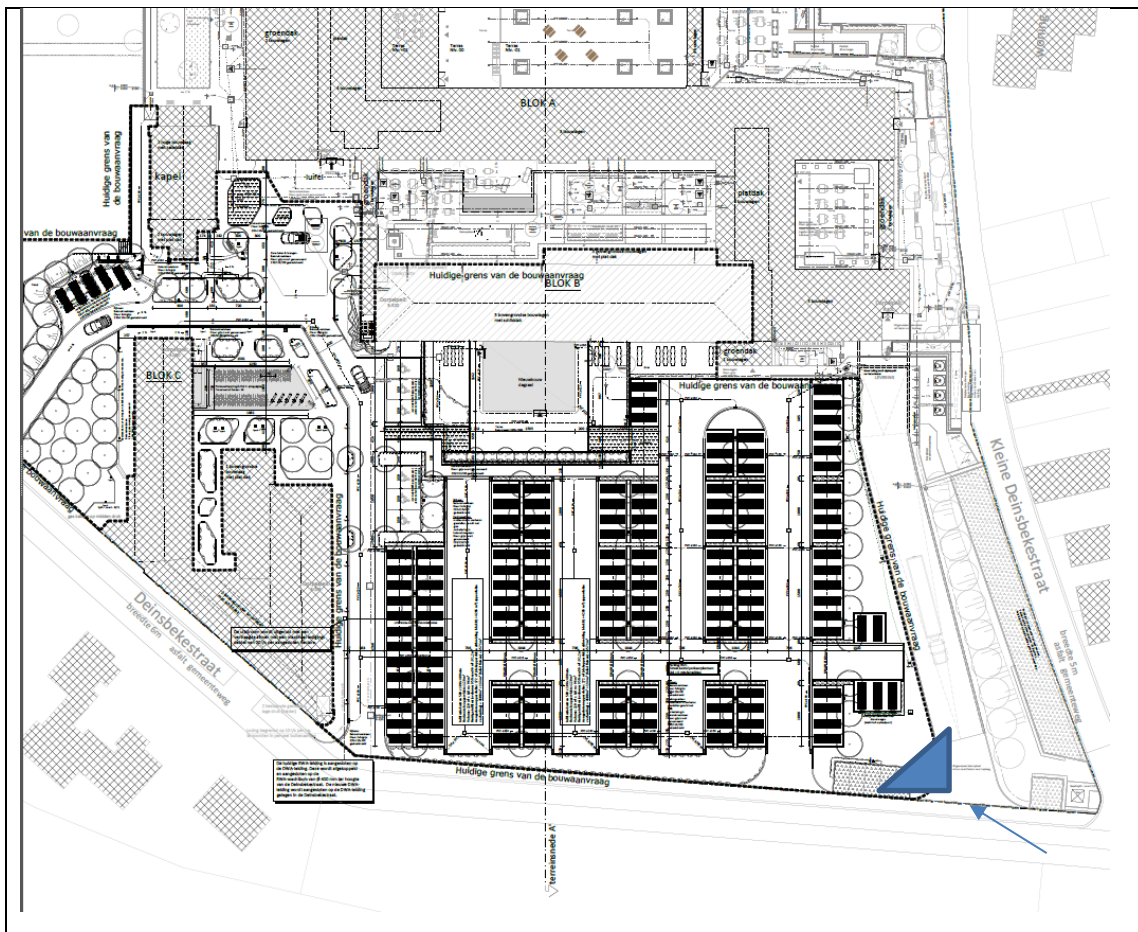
Bestaande toestand met overzicht voorlopige parking en werf
